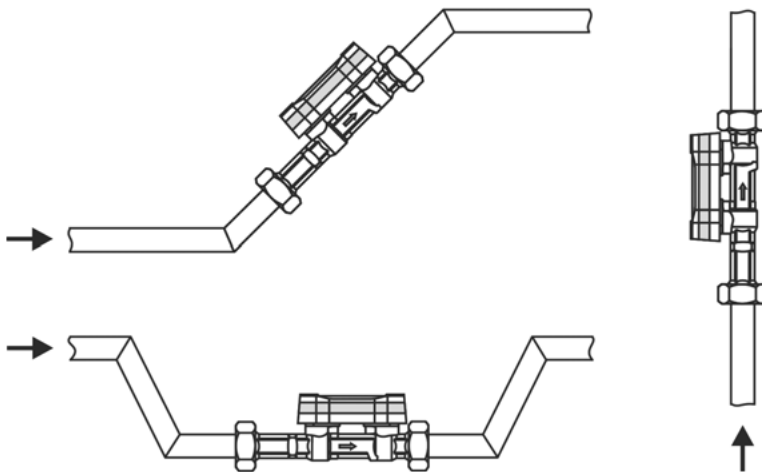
Рекомендуемая установка расходомера в трубопровод
